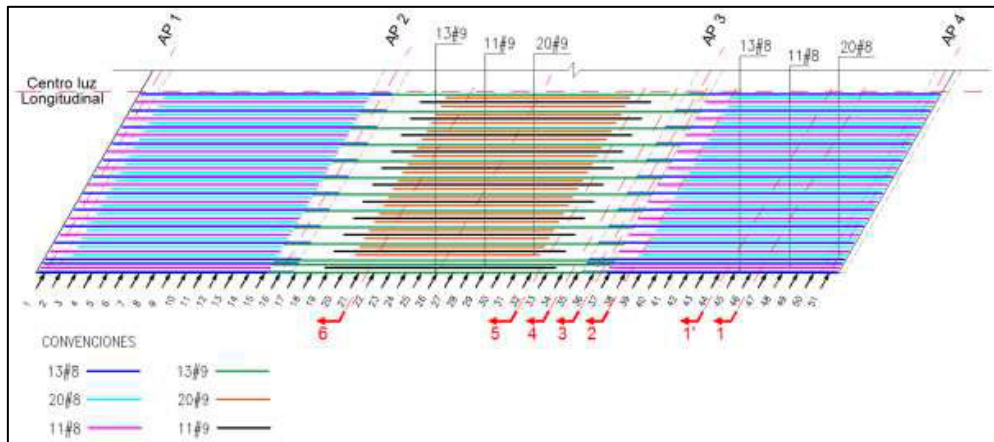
Planta refuerzo inferior superestructura puente No 2.
